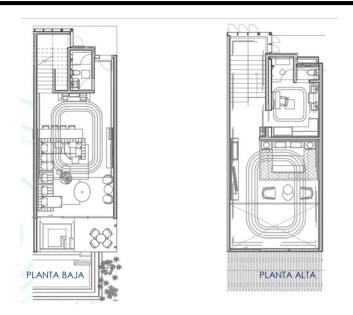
Diseño y distribución de los cuartos Desire suite en planta baja y planta alta que se pretenden construir en este predio.
